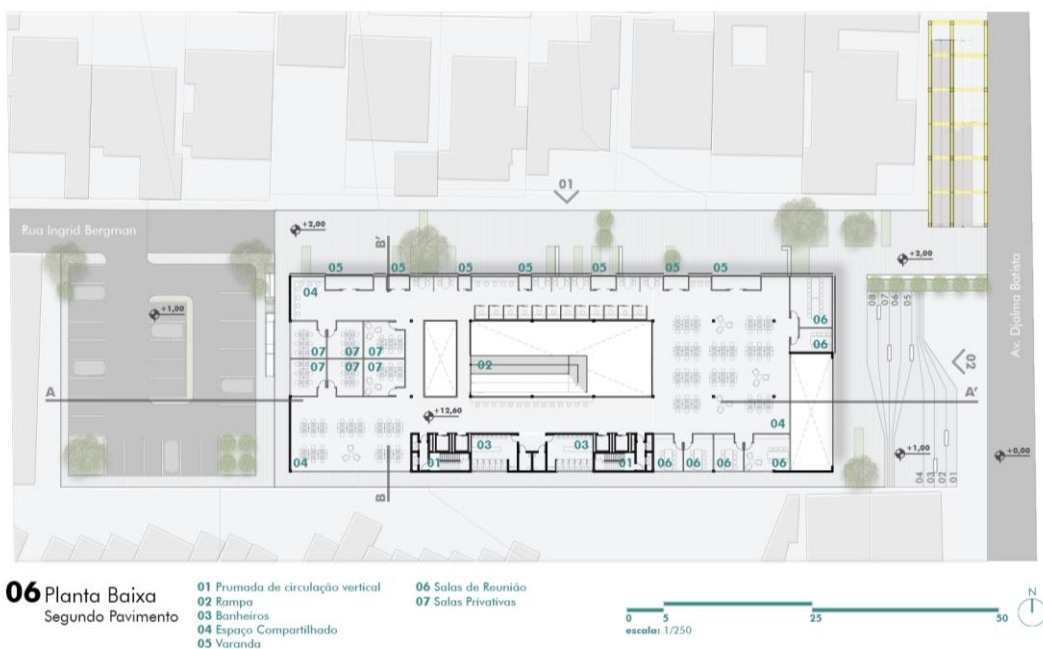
Planta Baixa Segundo Pavimento. Fonte: acervo da autora, 2021
